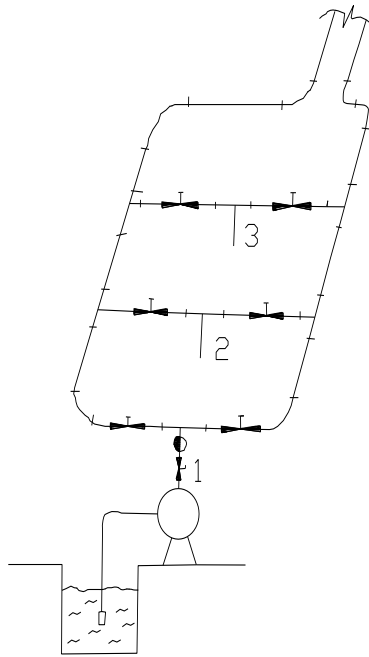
Гидравлическая схема расположения оборудования и трубопроводов в насосной станции.
